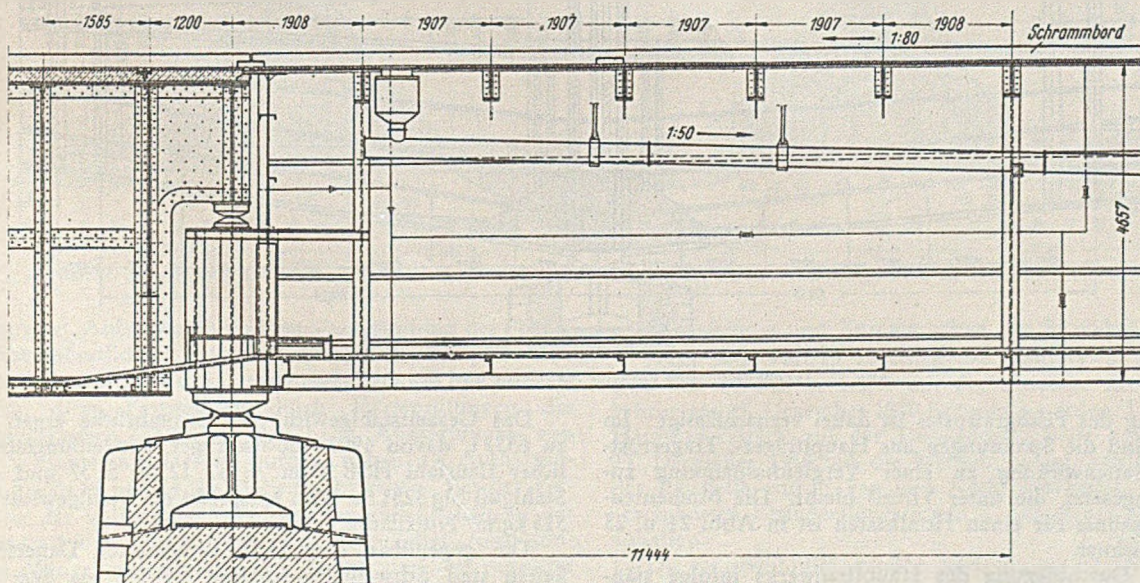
Innenansicht des äußeren Stegblechs im Endfeld.
